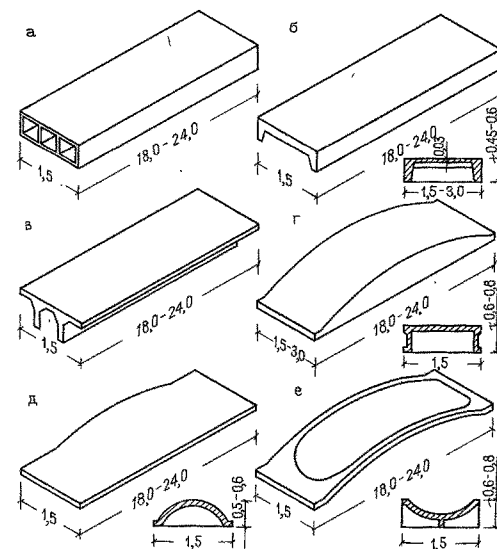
Длинномерные железобетонные сборные настилы покрытий
